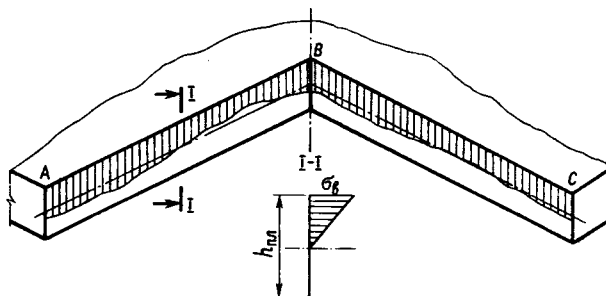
Эпюры сжатия по диагональным кромкам диска разрушения плиты (по данным испытаний фрагмента 2)
